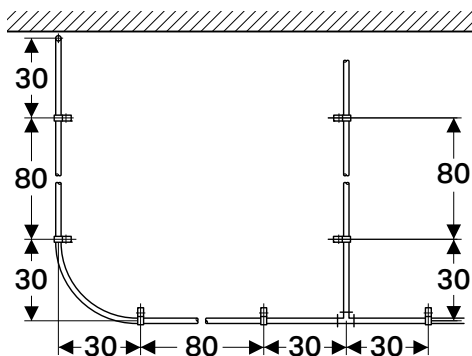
Befestigungsabstände Geberit Mepla Systemrohre ML (Rolle) auf der Rohbetondecke
